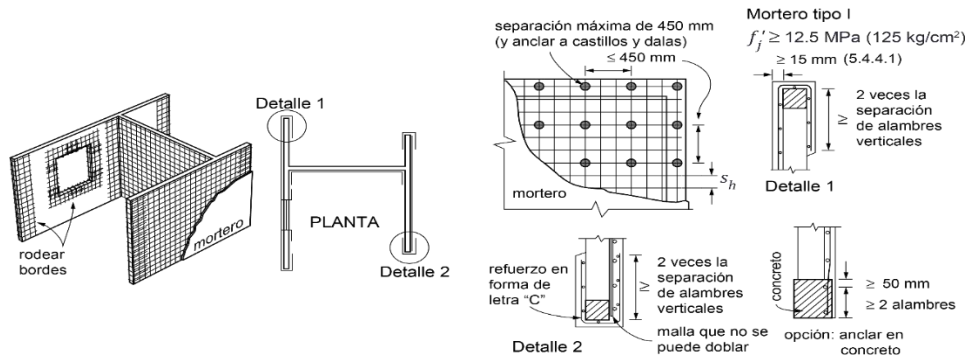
Refuerzo con malla de alambre soldado y recubrimiento de mortero
